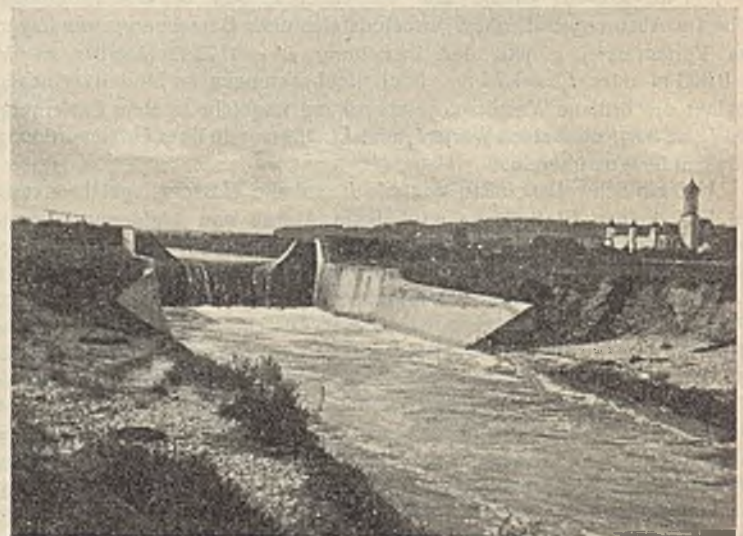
Uferanrisse an einem Absturzbauwerk in der Kammel mit parabelförmigem Absturzquerschnitt (Kulturbauamt Günzburg).
